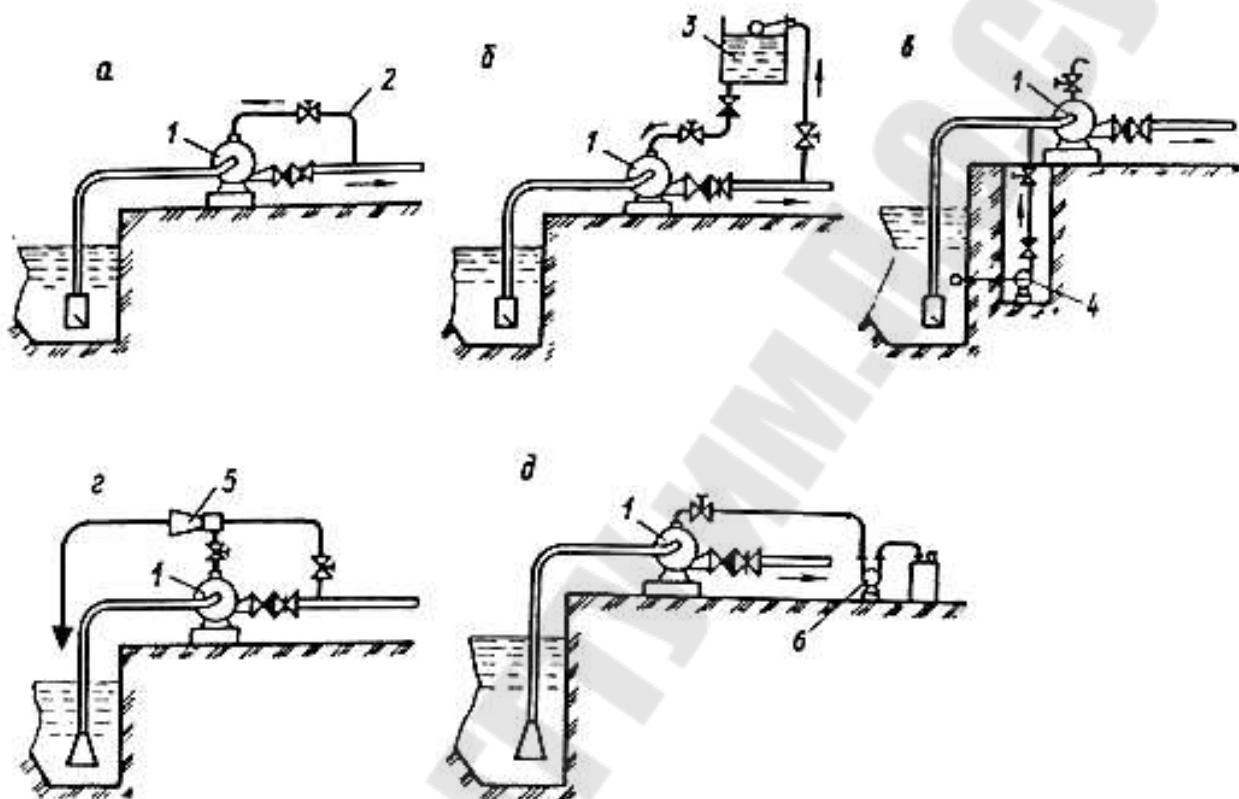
Схемы заливки насосов: а) из напорного трубопровода; б) из резервного напорного бака; в) специальным насосом; г) эжектором; д) вакуум-насосом; 1 – основной насос; 2 – трубопровод для заливки; 3 – резервный бак; 4 – специальный насос; 5 – эжектор; 6 – вакуум-насос
